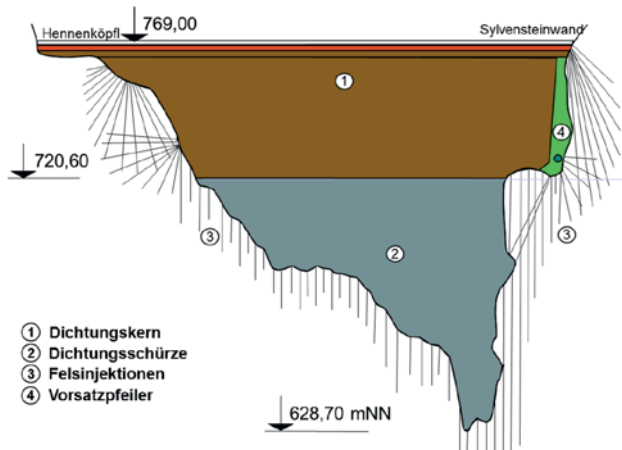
Längsschnitt durch den Sylvensteindamm mit Untergrund (WWA Weilheim)
